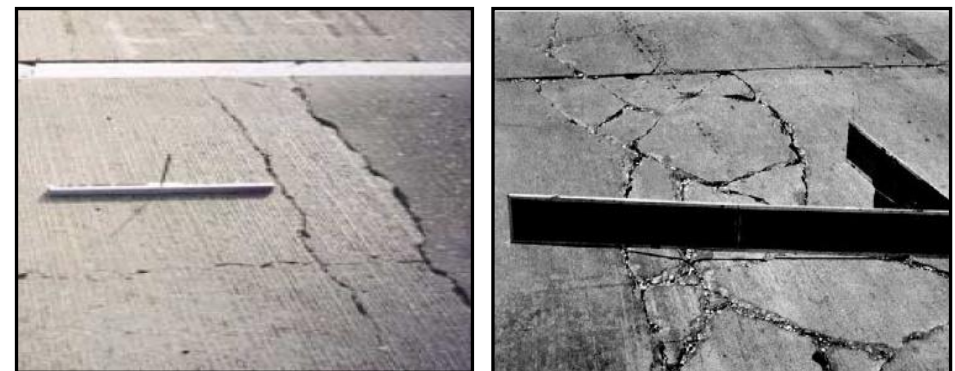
Esquema Punzonamiento (Punchout) - Pavimento Rígido
